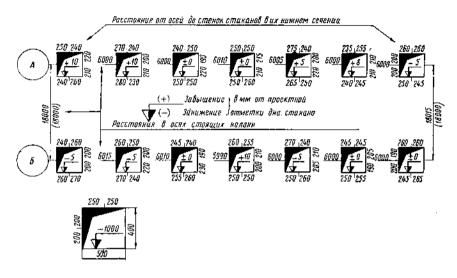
Исполнительная схема планово-высотного положения стаканов фундаментов под железобетонные колонны
